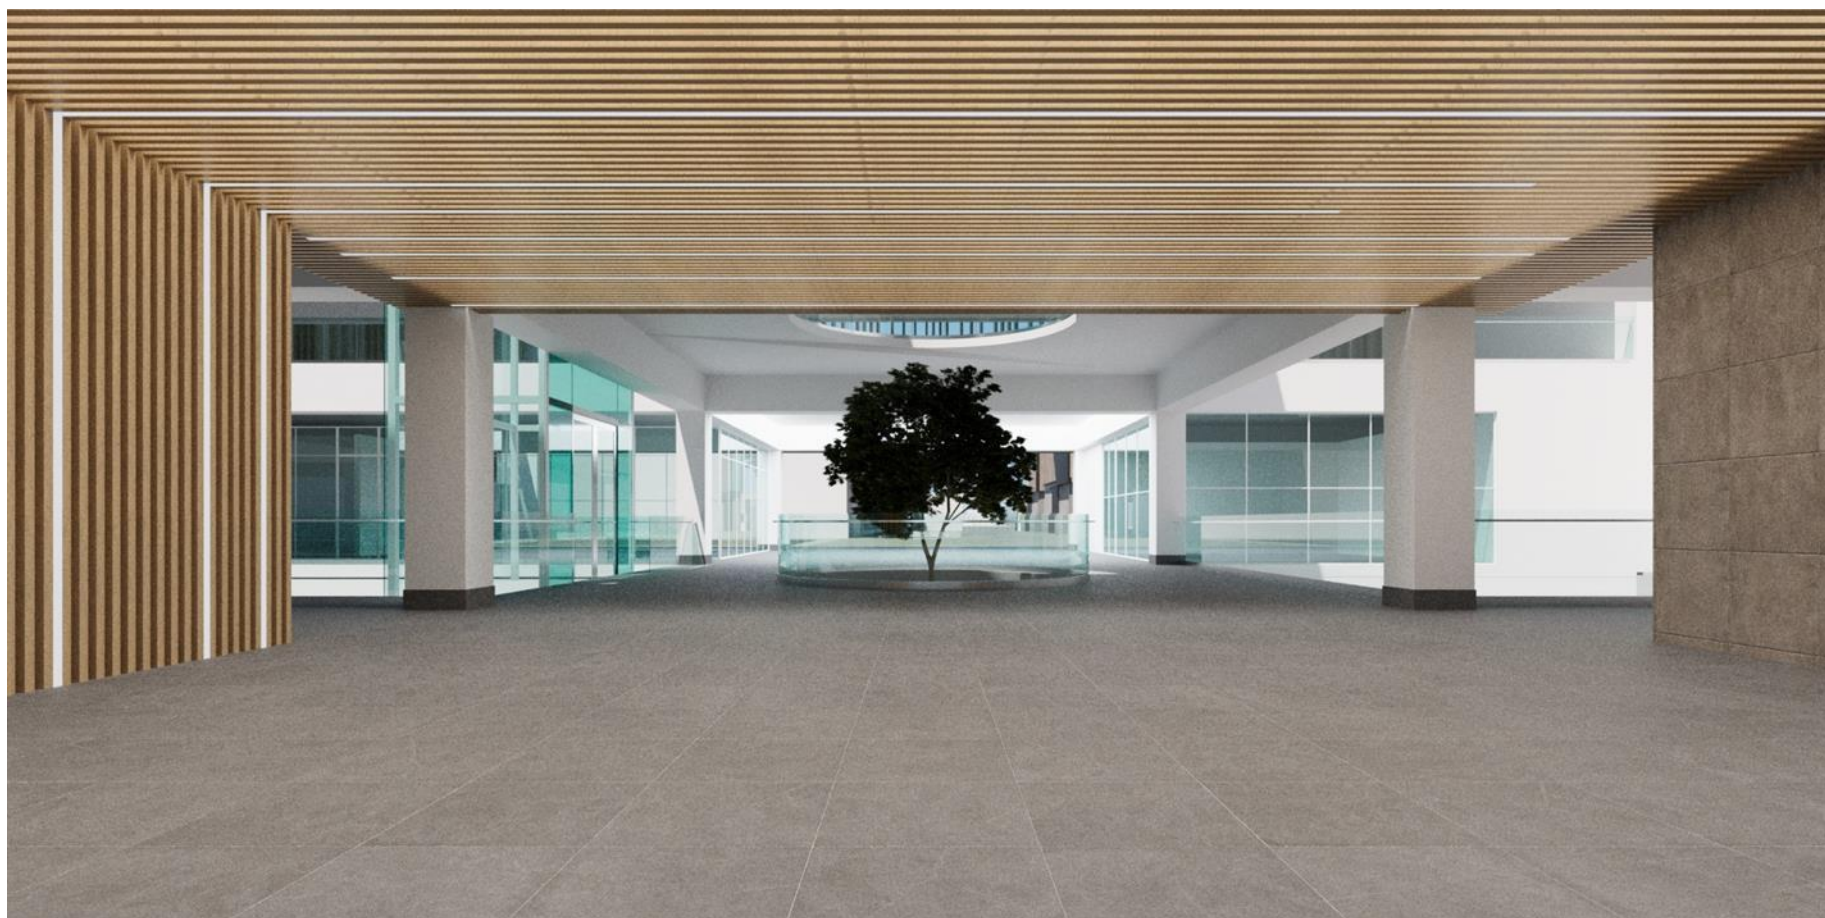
Vista 3d – Fachada Lateral derecha
